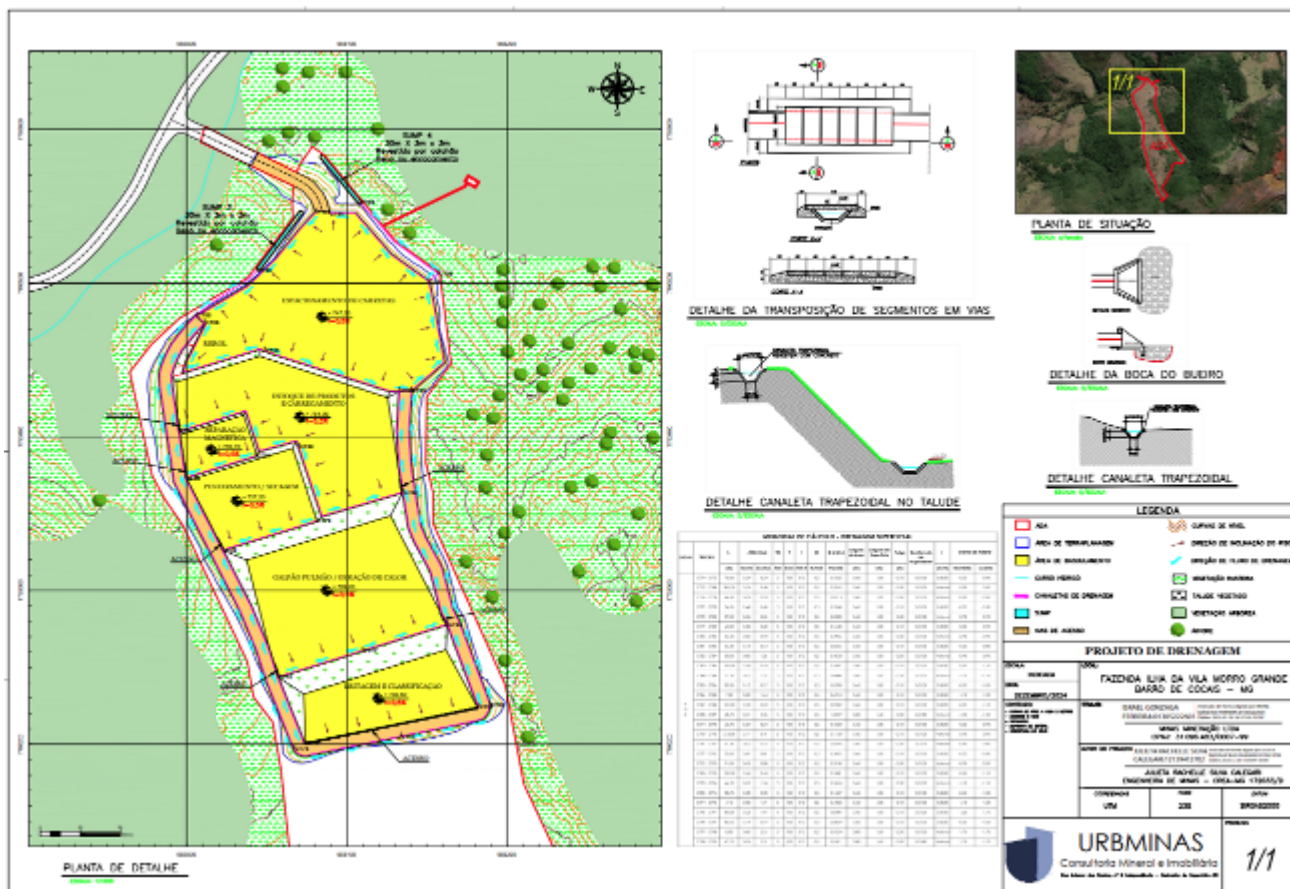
Layout do sistema de drenagem pluvial projetado para a área operacional do empreendimento.
